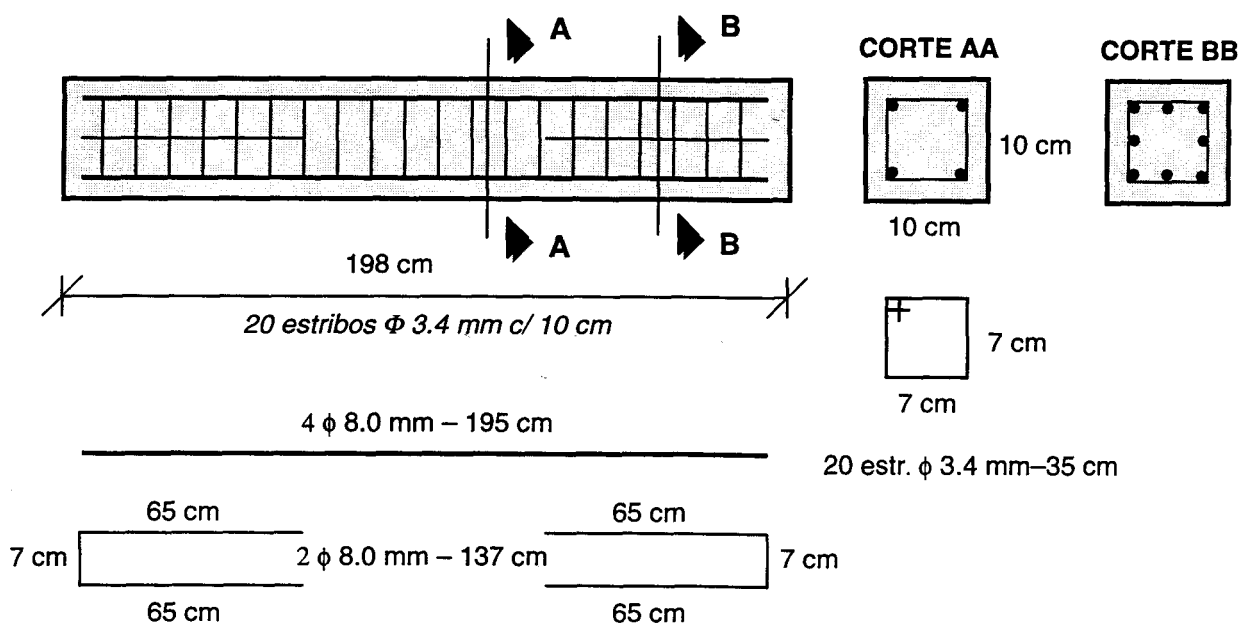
Detalhe da forma e armadura dos pilares testemunhos.
